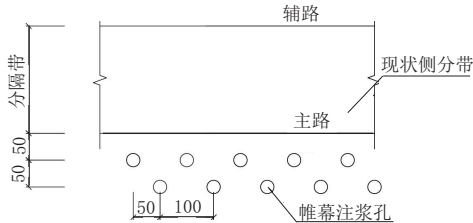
帷幕注浆平面布置示意图(绿化保护)(单位:cm)
